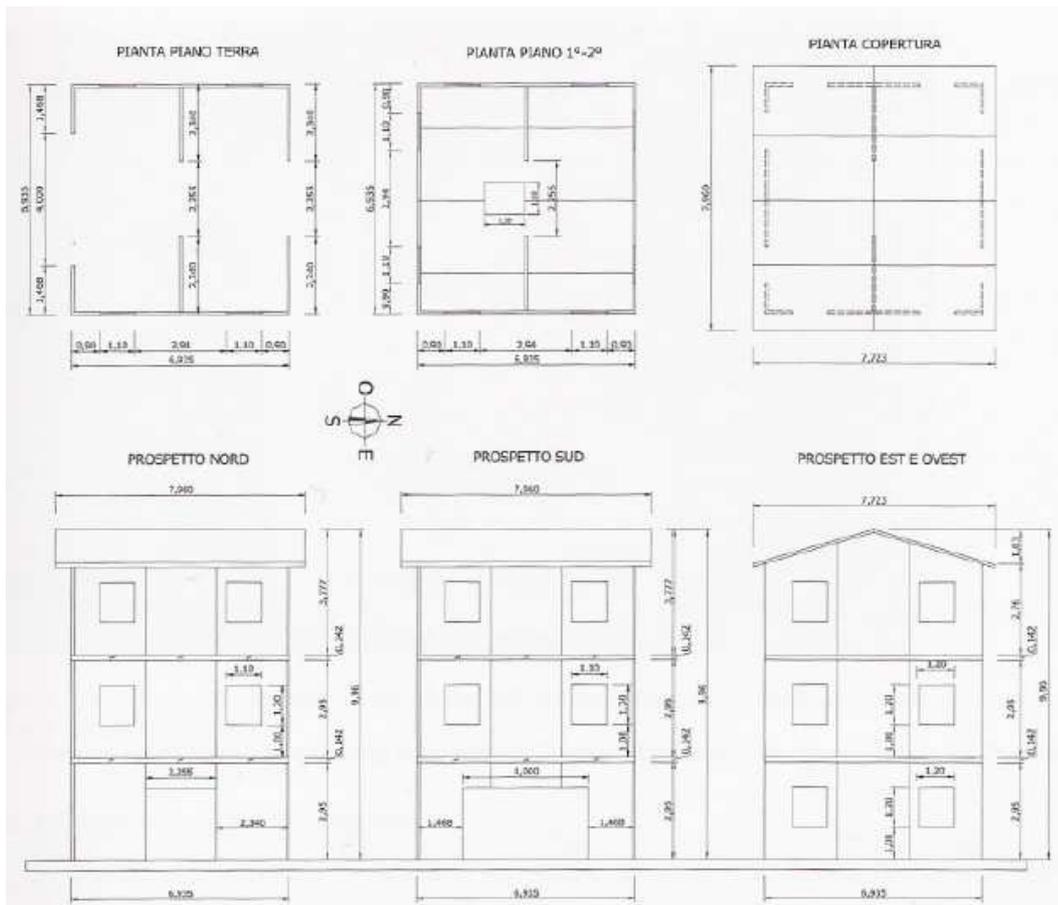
Piante e prospetti dell'edificio a 3 piani.
